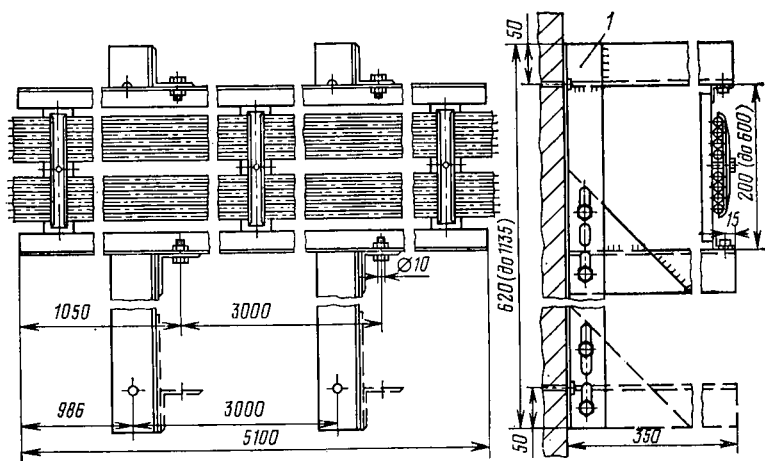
Установка блока труб с несущим каркасом на вертикальной стене.
